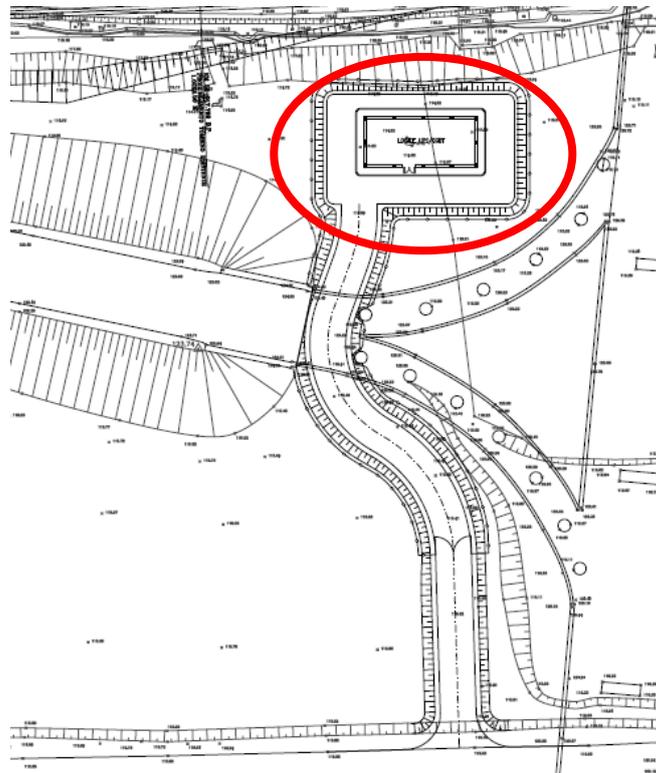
Planimetria piazzale. Cerchiato in rosso il nuovo edificio descritto nel paragrafo precedente
